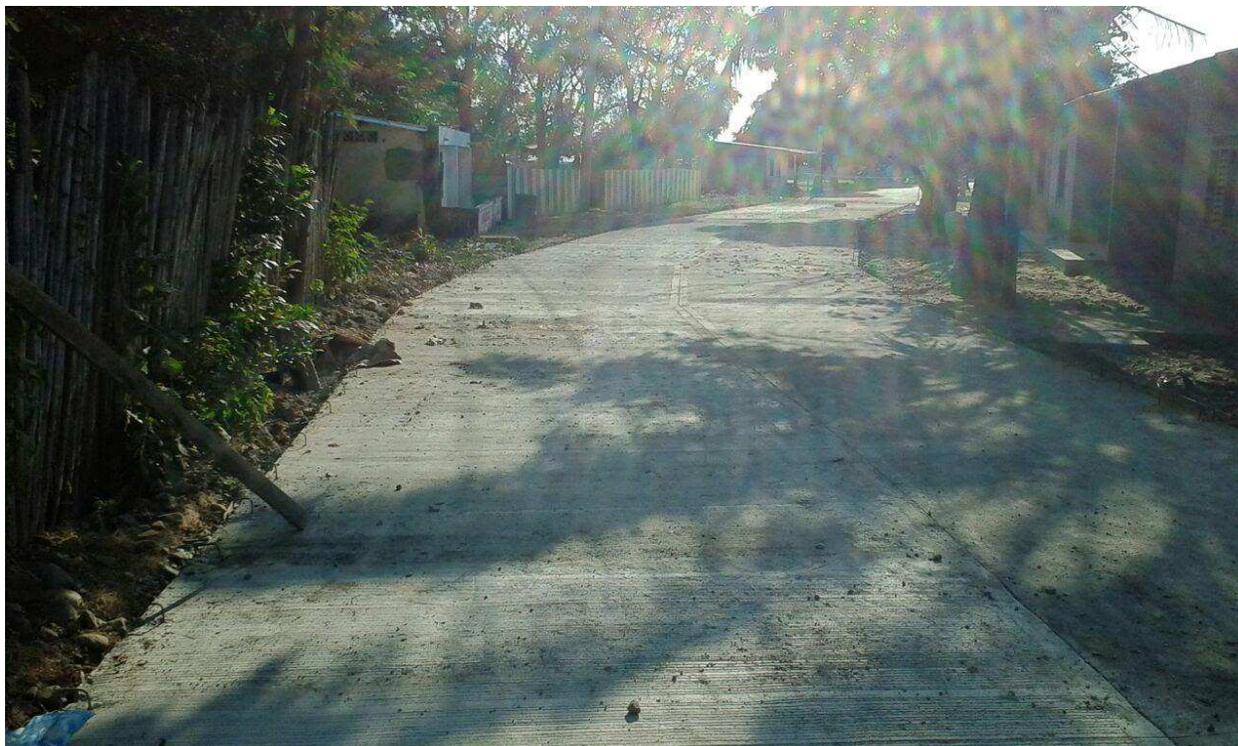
Pavimento terminado calle 9 carrera 6-6ª
